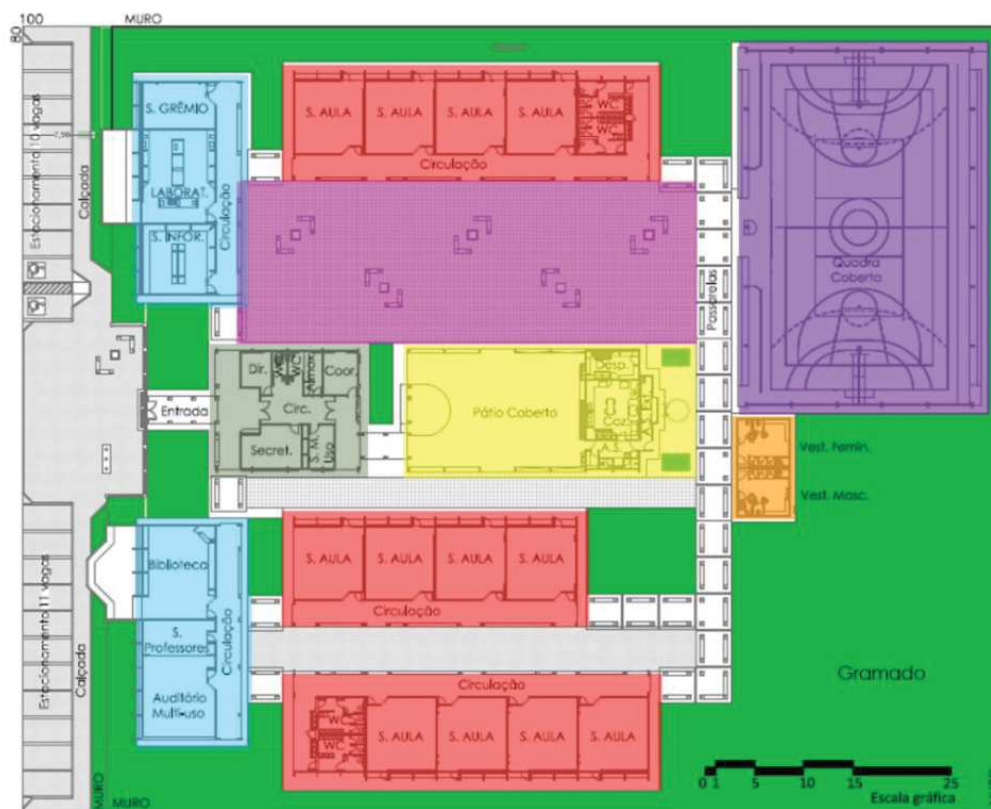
Planta baixa de implantação da PEE12 - FNDE (Adaptado de FNDE, 2020).
